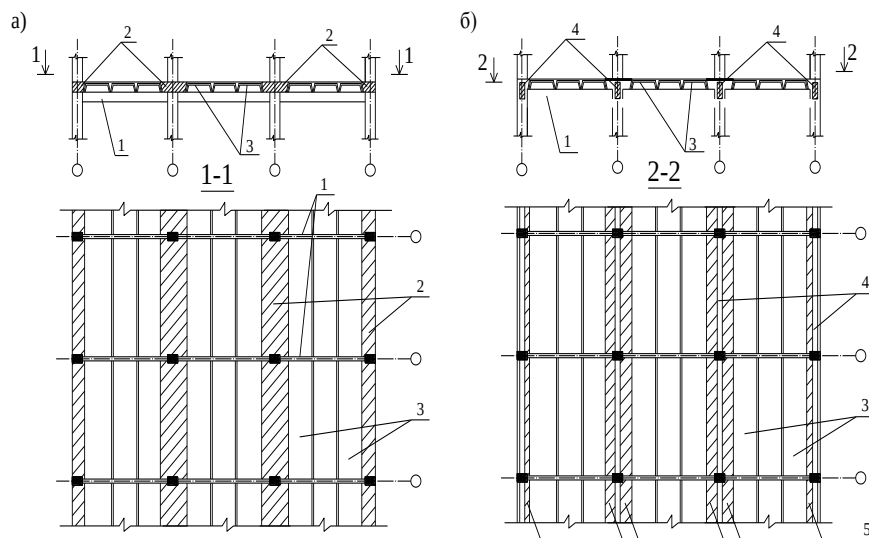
Схемы расположения продольных монолитных (а) и сборных (б) ригелей: 1 - поперечные ригели; 2 - монолитные продольные ригели; 3- плиты перекрытий; 4-сборные продольные ригели; 5-монолитные участки
